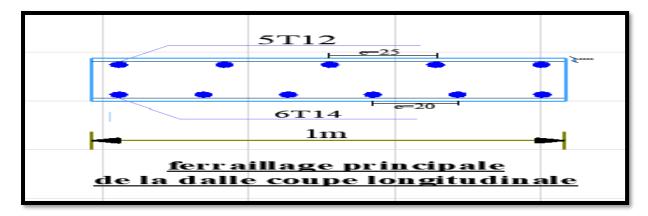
Ferraillage principale de la dalle coupe longitudinale du tablier
